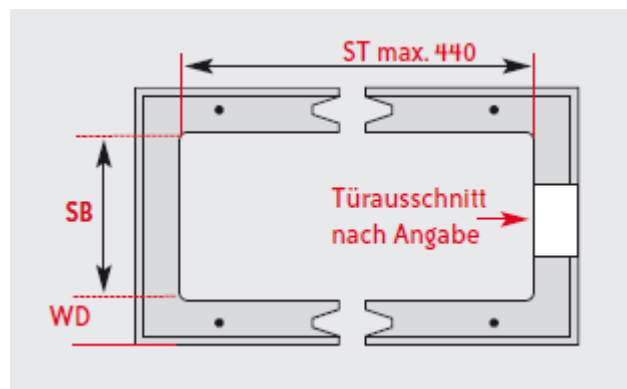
Konstruktionsprinzip 3 – Aufzugsschacht
